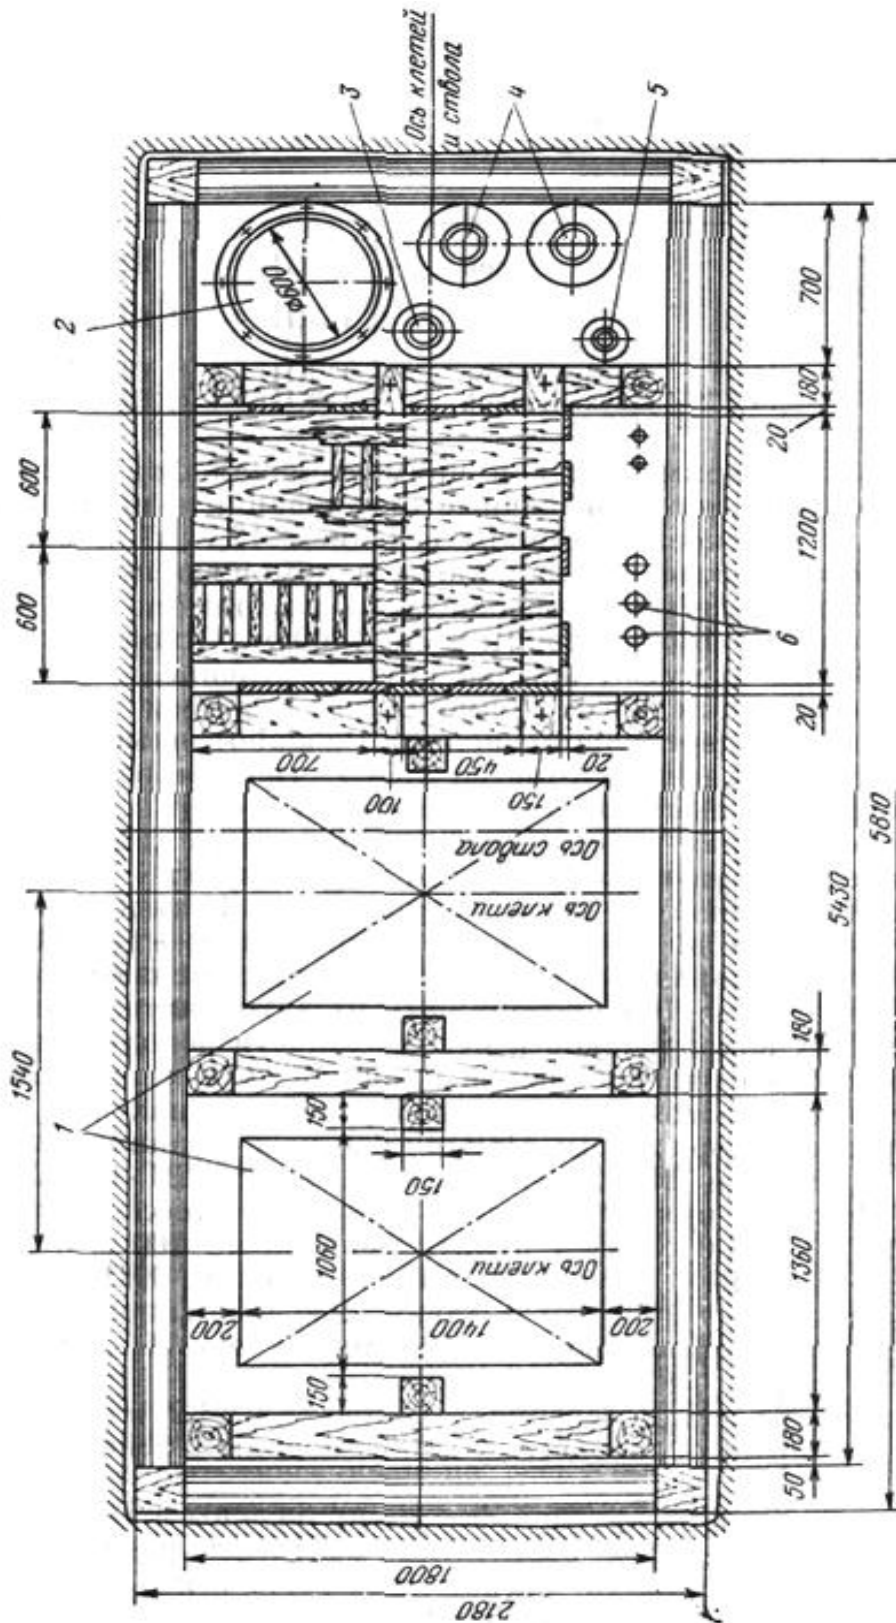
Типовое прямоугольное сечение ствола разведочной шахты площадью  $14,2 \text{ м}^2$ : 1 – шахтные клетки; 2 – вентиляционный трубопровод; 3 – трубопровод для подачи сжатого воздуха; 4 – трубы для водоотлива; 5 – трубопровод водоснабжения; 6 – электрические кабели
